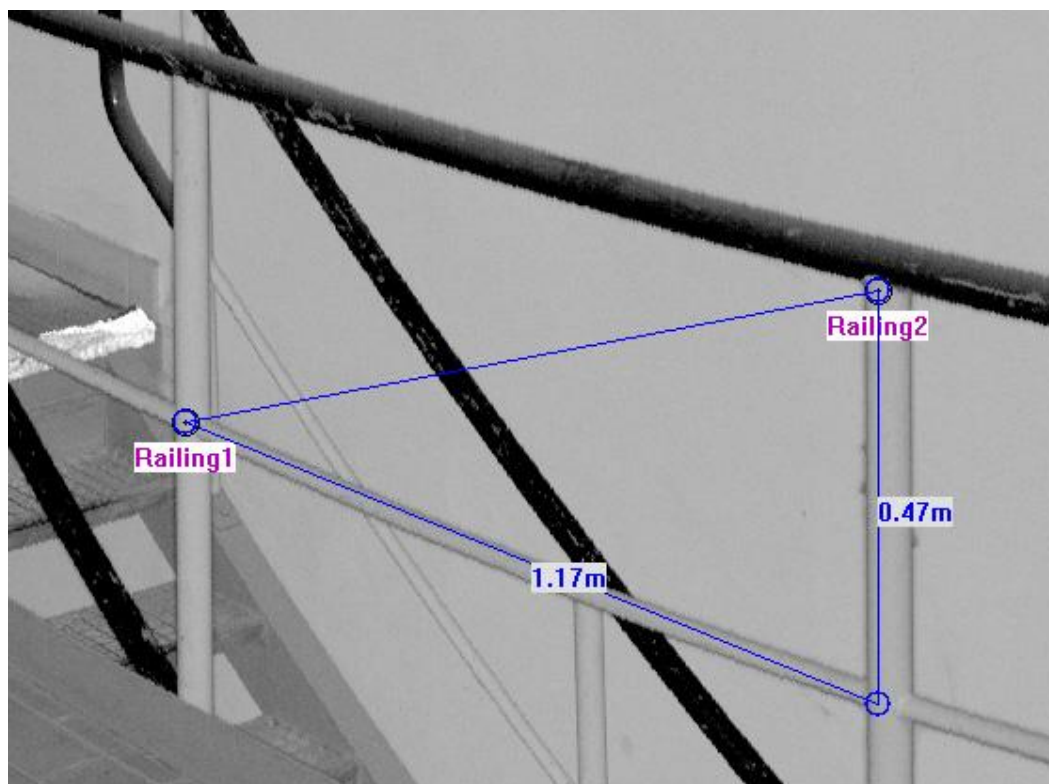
Straight-line measurement – přímý výběr souřadnic
